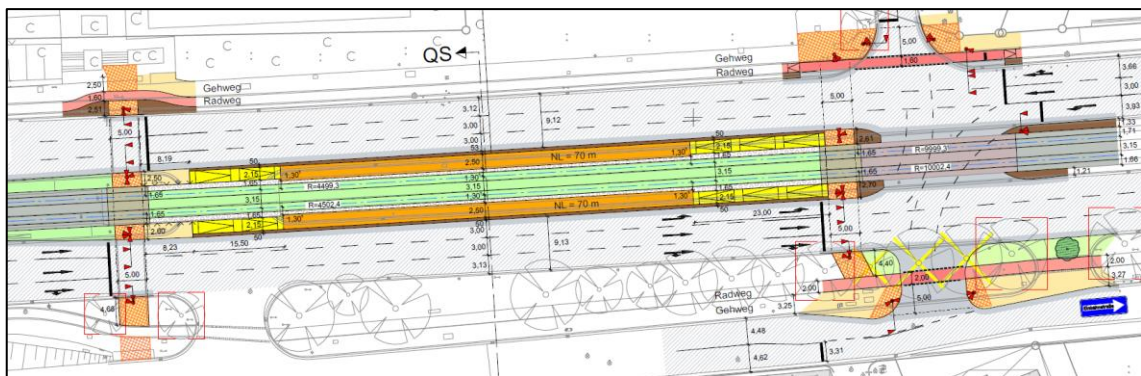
Ausschnitt Lageplan Variante 2c (MBU), V2c_VA0LA1
